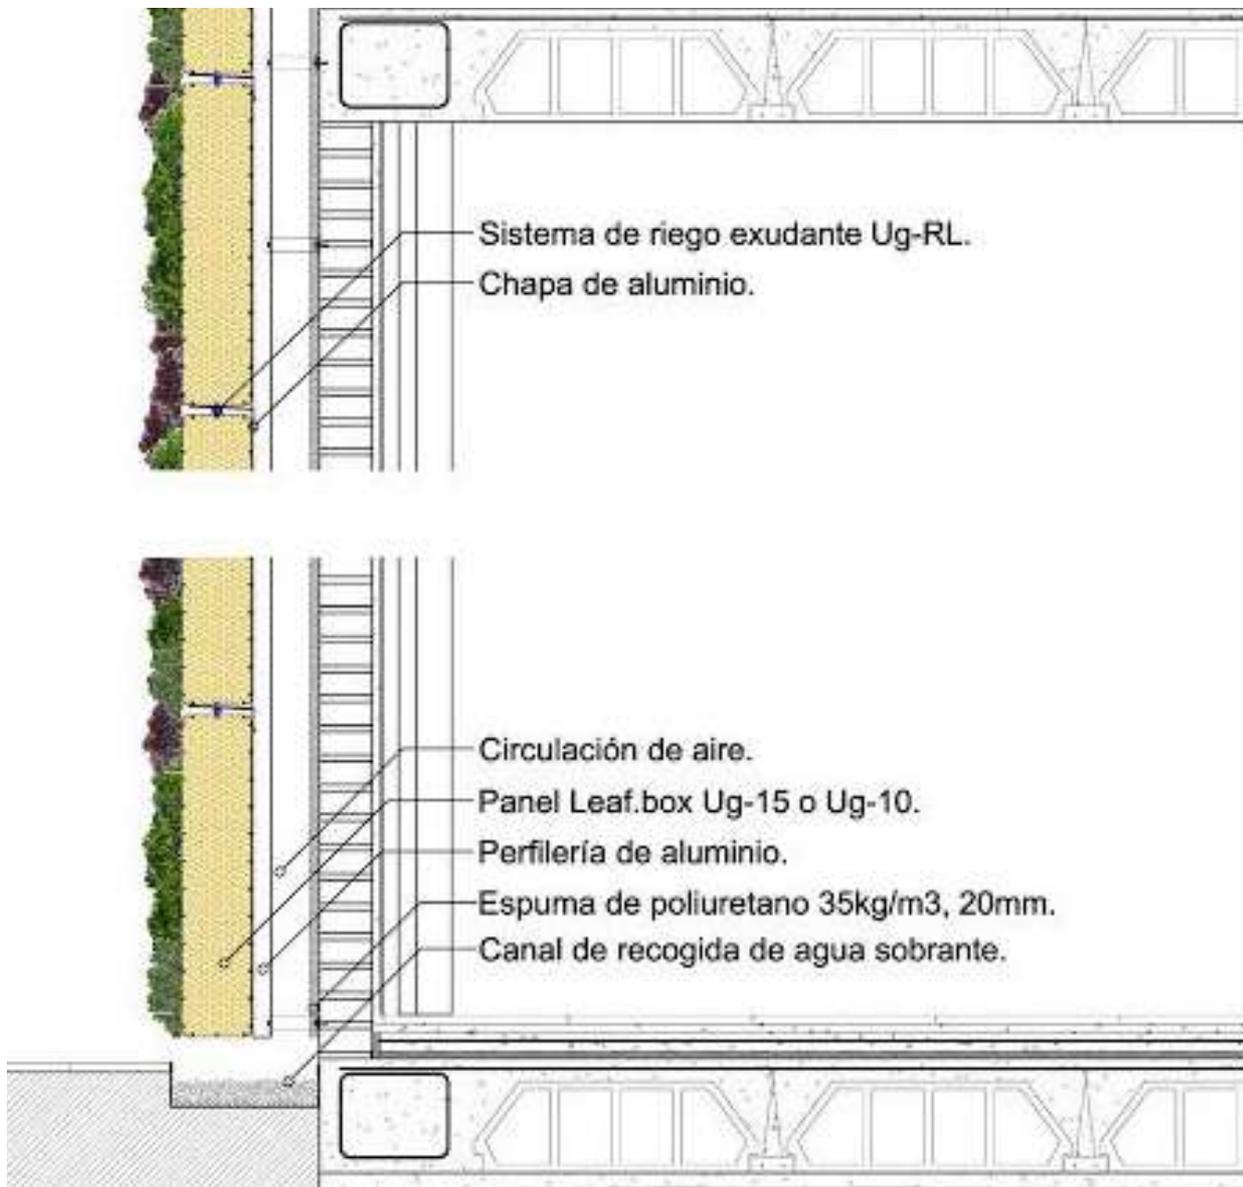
Detalle Fachada vegetal sistema Leaf Box.
